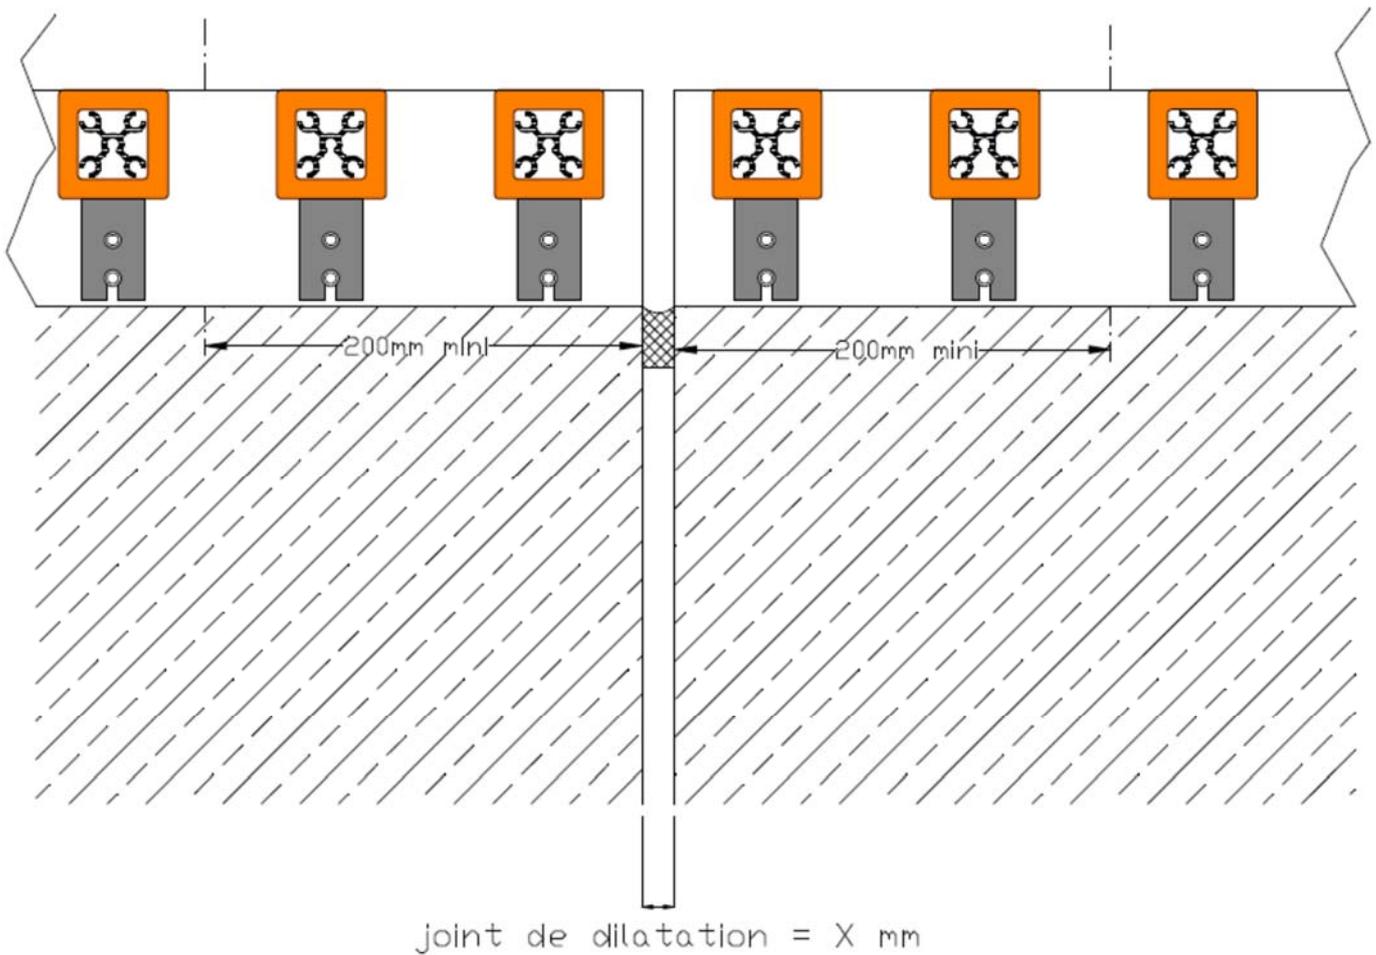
a – Pose verticale, joint de dilatation avec profil de section rectangulaire
